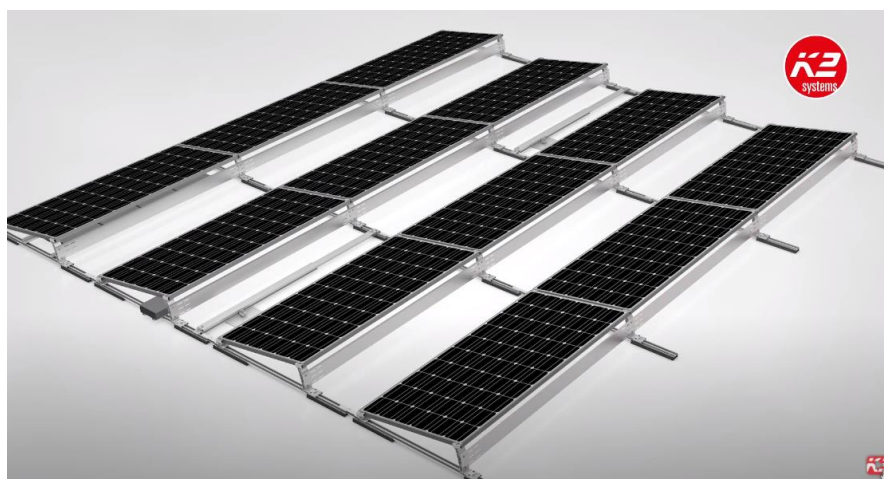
Vista general estructura suport a coberta sistema S-DOME 6.10
